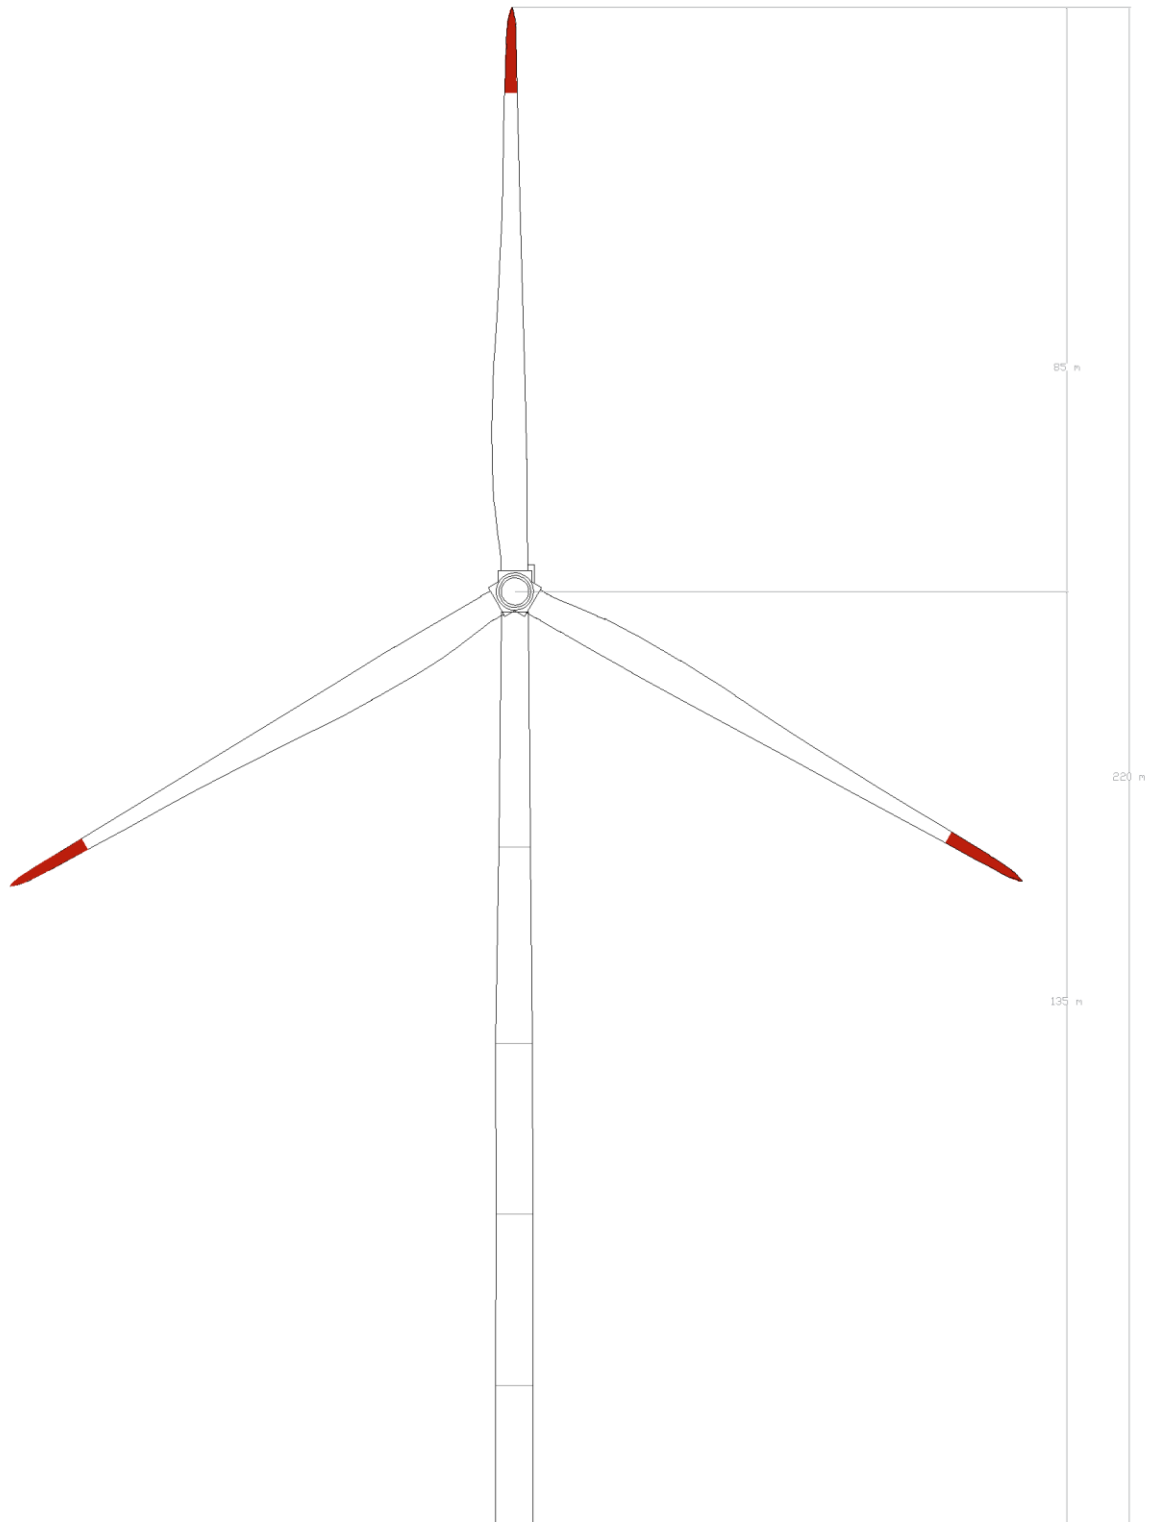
Segnalazione cromatica su prospetto frontale dell'aerogeneratore
